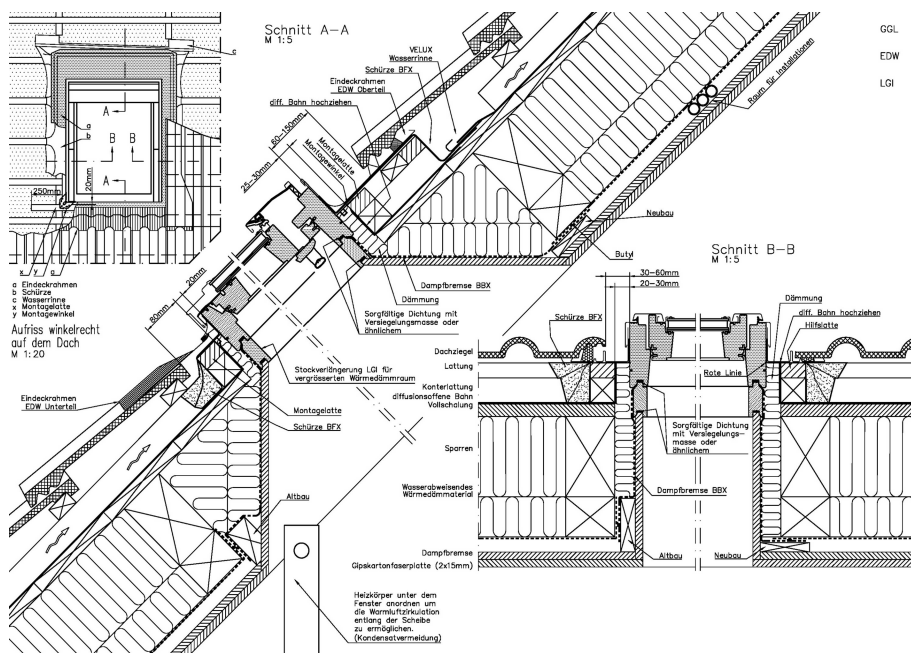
Dachflächenfenster (Beispiel Velux)– Detailsausbildung [Quelle: Riccabona/Mezera, Baukonstruktionslehre 2 (Ausgabe 2011) 388]
